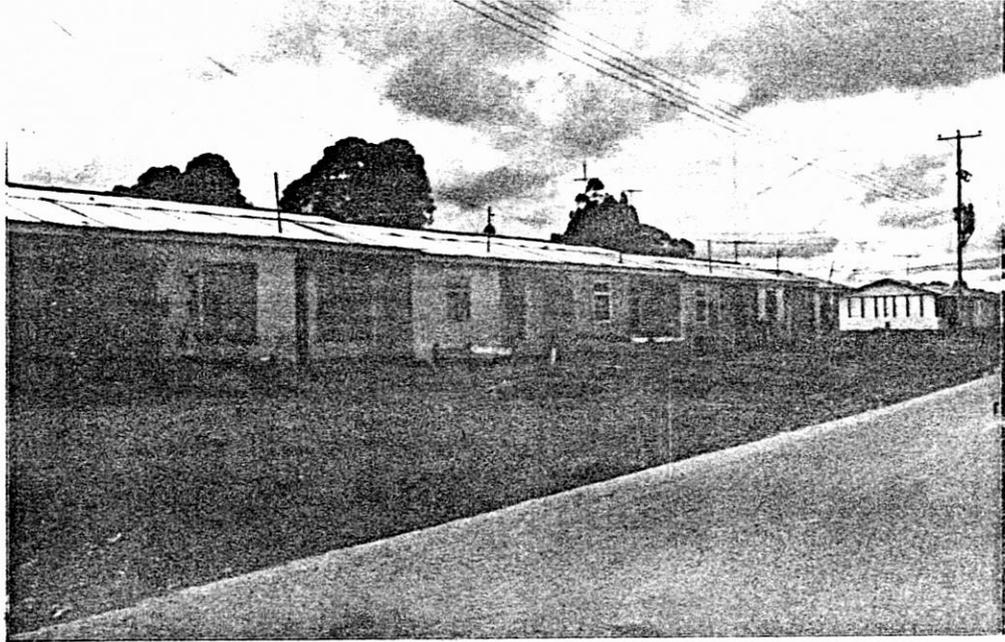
Vivienda tipo popular prefabricada (Popayán)
